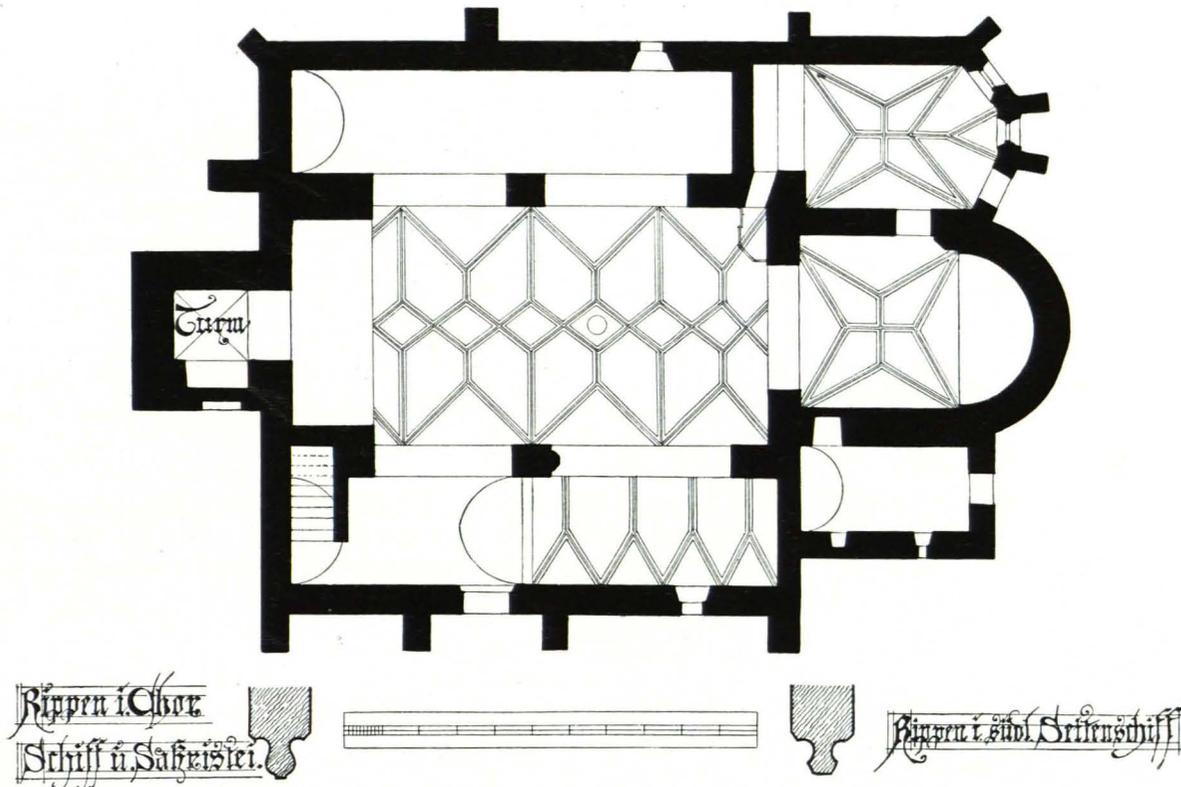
Purk, Pfarrkirche, Grundriß 1:200 (S. 193)
